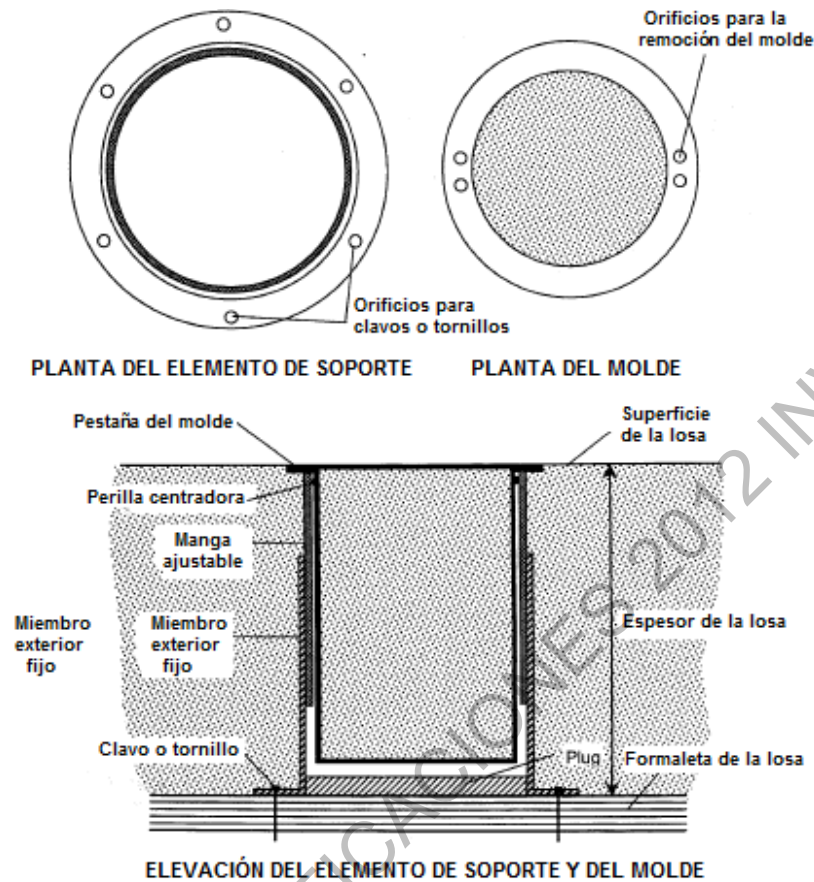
1. Esquema del ensamble del molde para fundir cilindros in-situ
